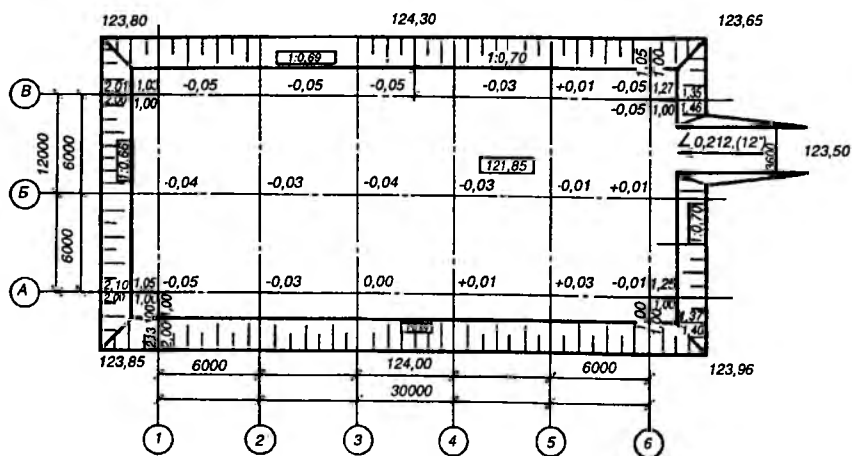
Образец оформления плано-высотной съемки котлована (действительные размеры даны над размерными линиями, проектные – под линиями). На чертеже показаны: 0,05 – отклонение отметки дна котлована от проектной, 121,85 – проектная отметка дна котлована, 1:0,71 – крутизна откоса по проекту, 1:0,69 – крутизна откоса в натуре, 123,85 – отметка верхней бровки котлована (все размеры кроме осевых и отметки даны в метрах, отметке чистого пола соответствует абсолютная отметка .124,00 = 0,000)
